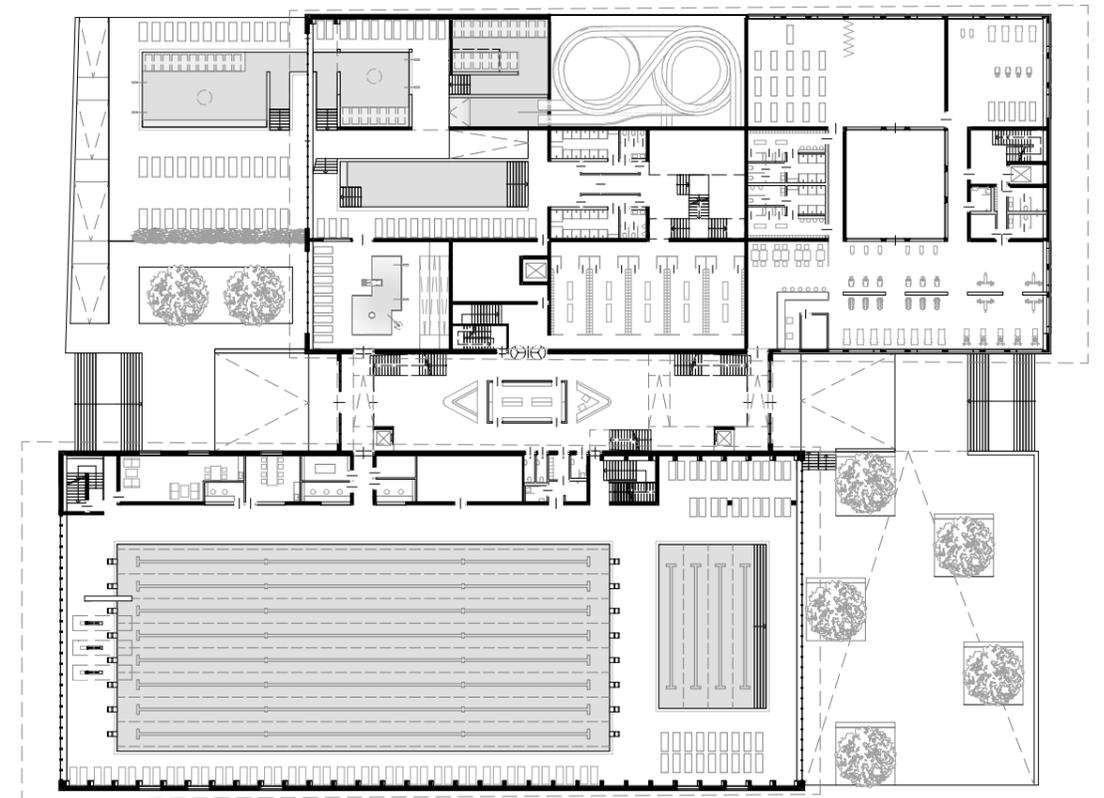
Grundriss 1.Obergeschoss 1:750
